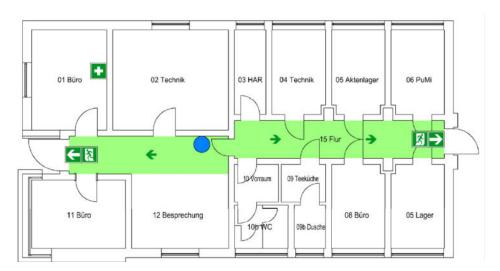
Grundrissplan Erdgeschoss, Gebäude FB
